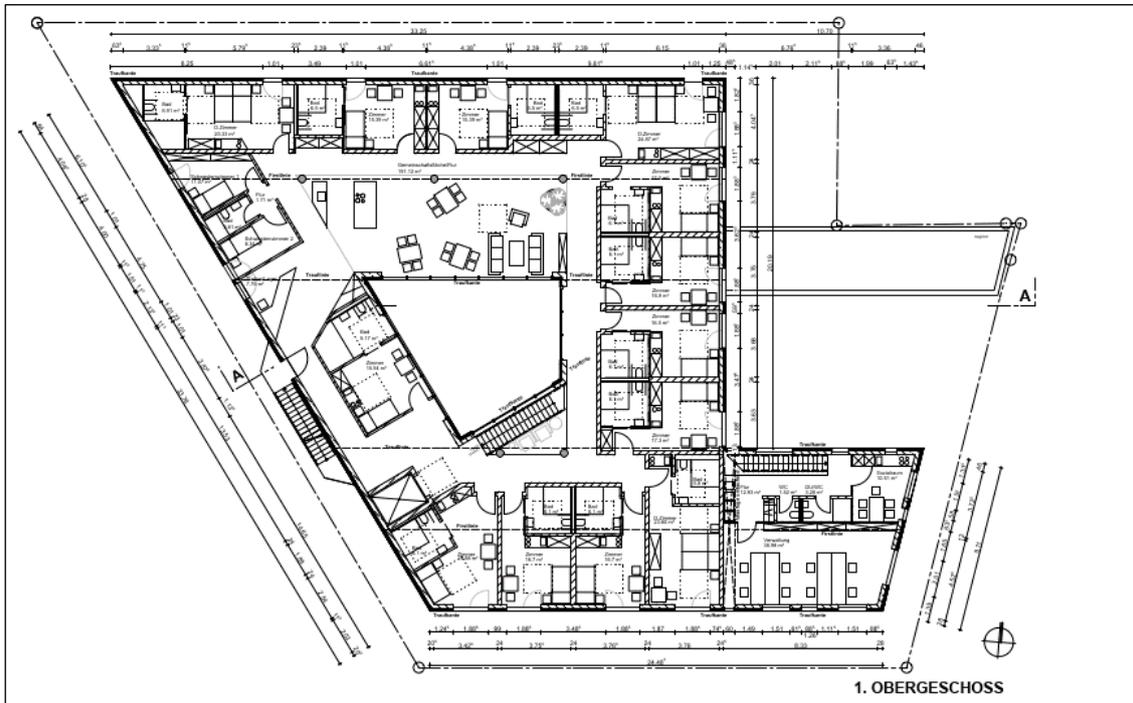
Grundriss des Obergeschosses /13/
